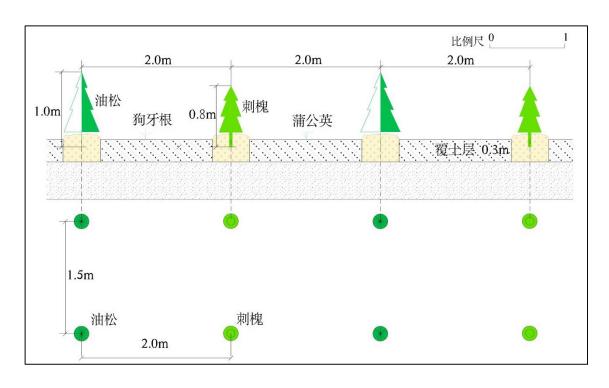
开拓平硐及硐外场地复垦工程设计立面图、平面图
